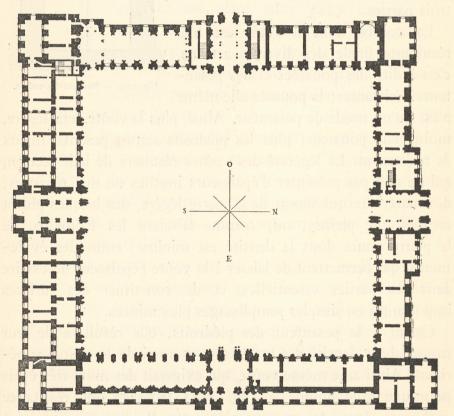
Plan du rez-de-chaussée du Louvre.
